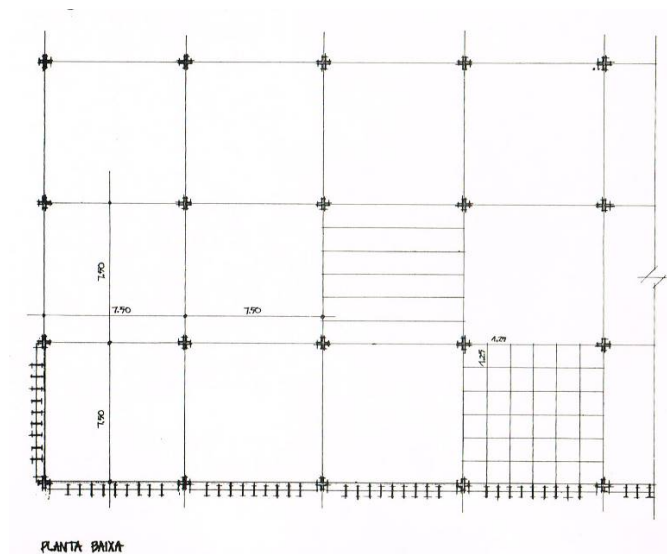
Planta da modulação da estrutura proposta para os edifícios do Plano Piloto
